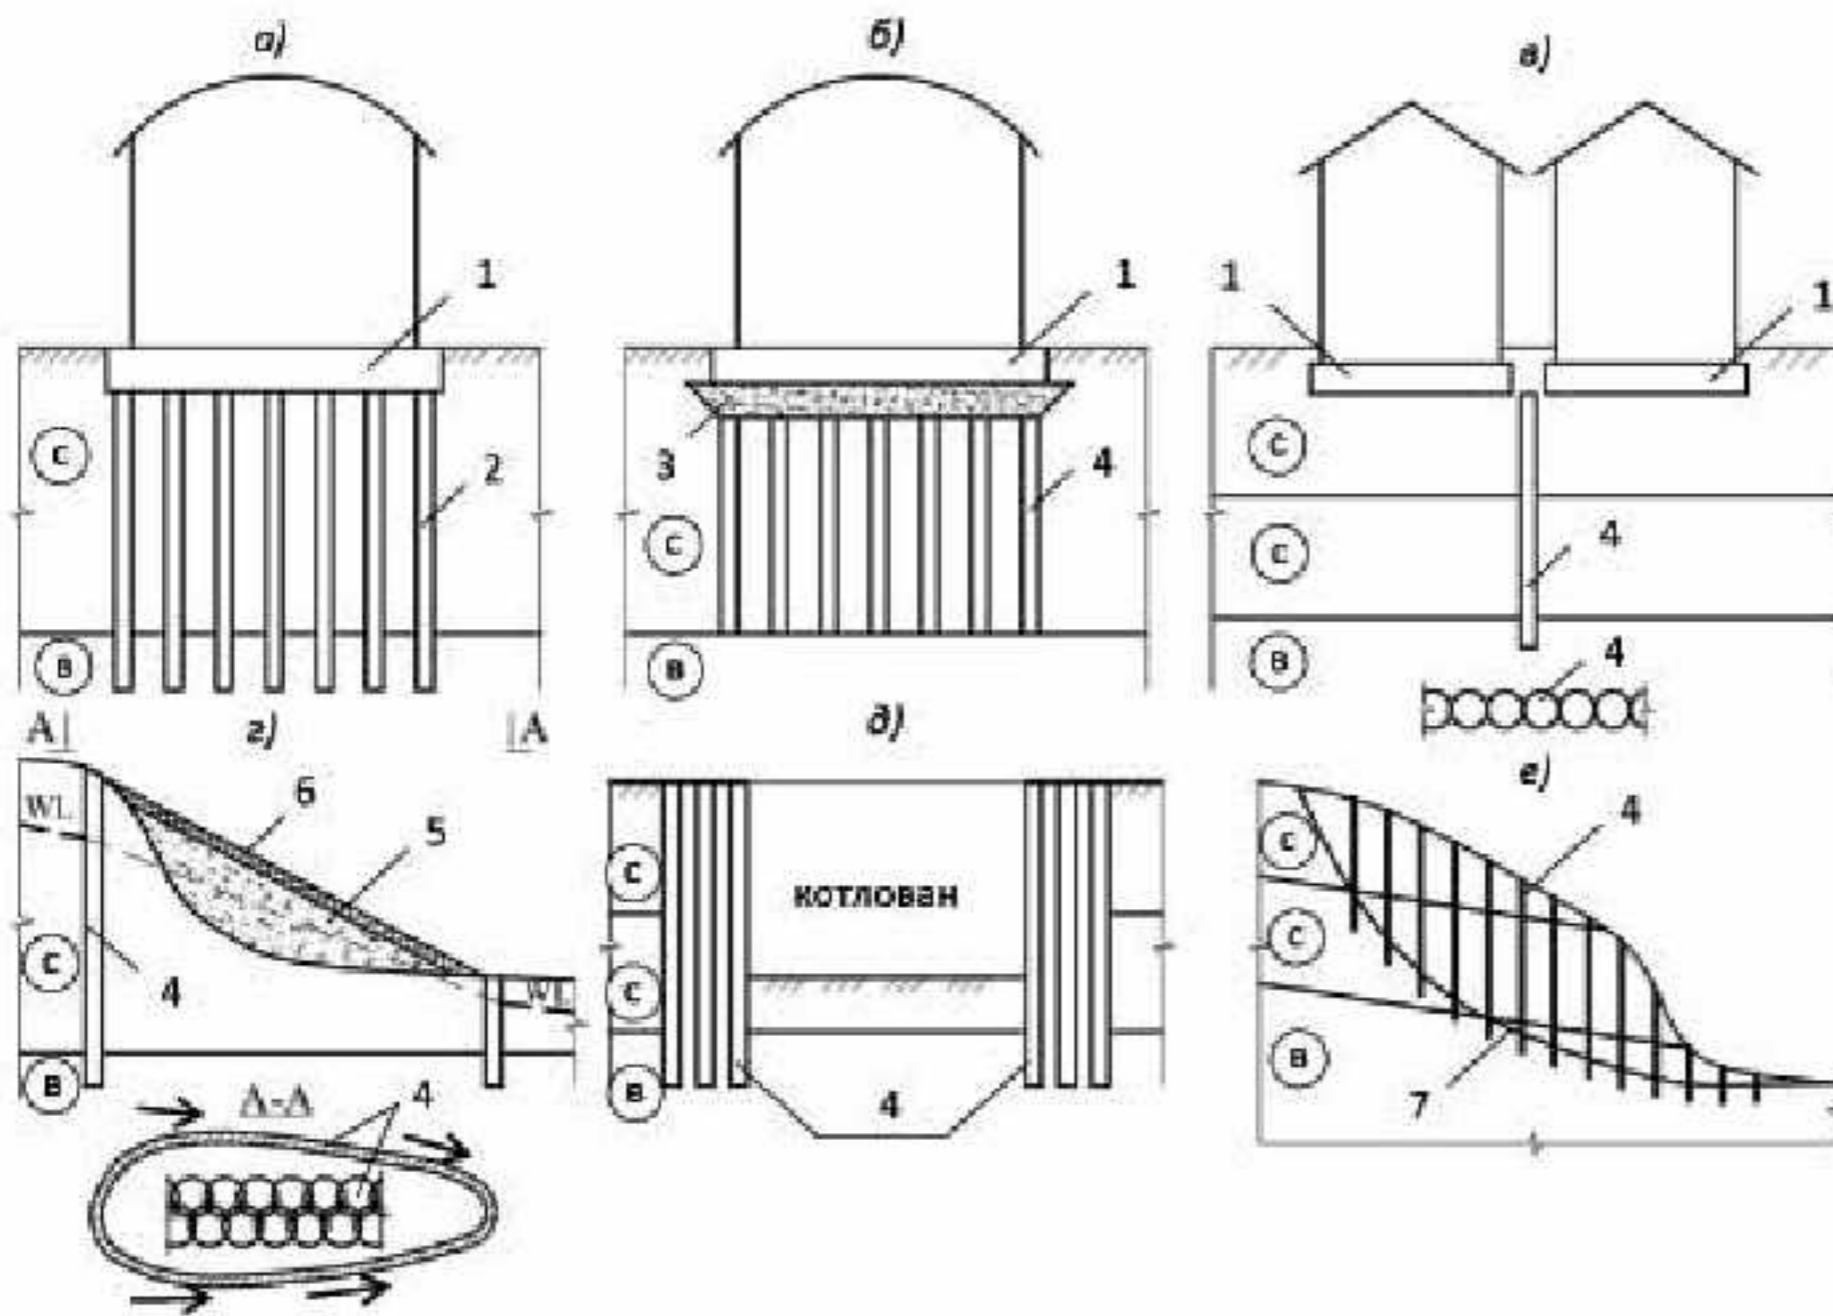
Применение грунтоцемента в строительстве: а) в качестве свайного фундамента; б) для усиления основания фундамента; в) в качестве разделительной стенки; г) при засыпке оврагов отходами; д) для укрепления стенок котлована; е) для закрепления склонов: 1 – фундамент здания; 2 – грунтоцементная свая; 3 – щебневая подушка; 4 – грунтоцементный элемент; 5 – отходы; 6 – рекультивационный слой; 7 – поверхность скольжения
